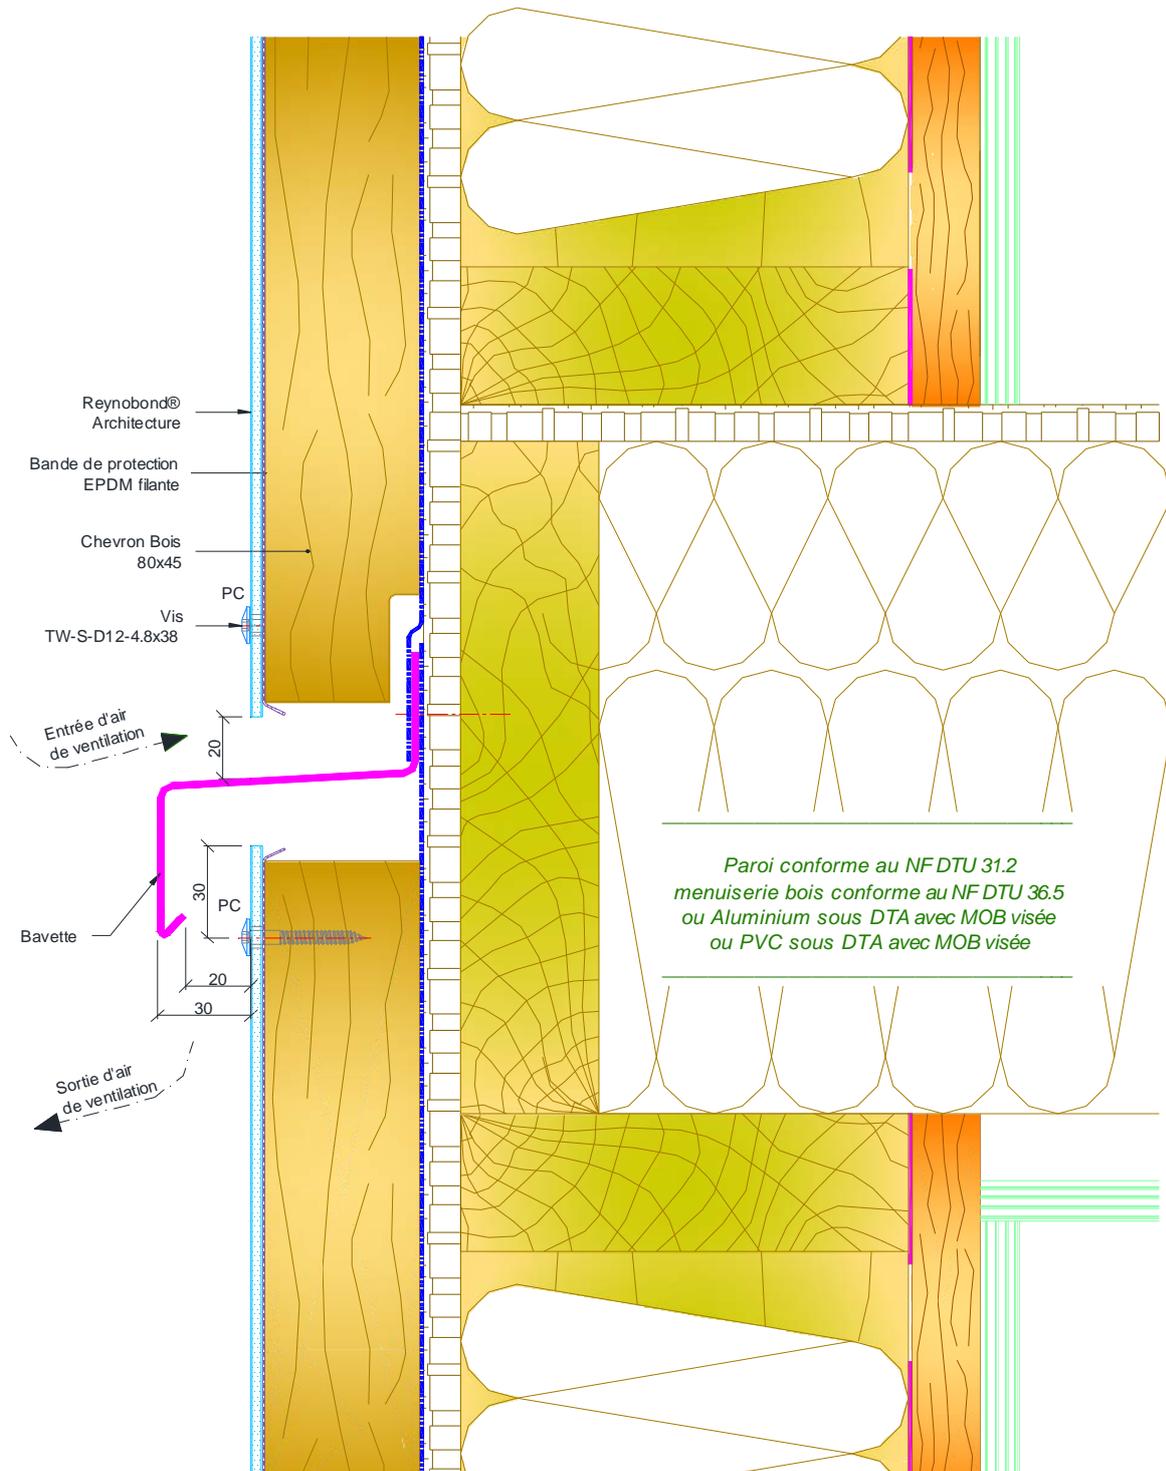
Fractionnement de l'ossature et recoupement du pare-pluie tous les 6 m sur COB
